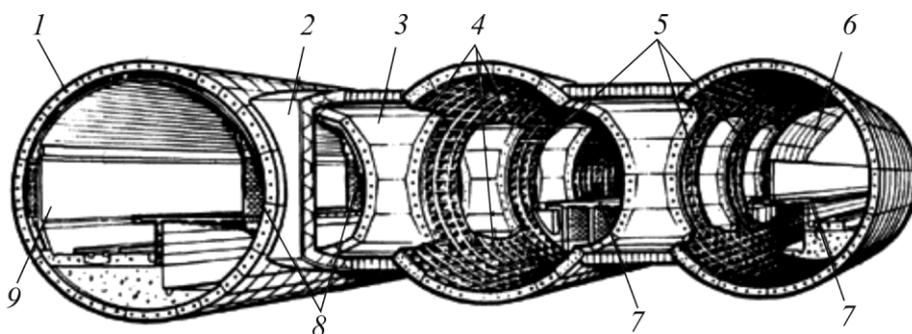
Трехсводчатая схема пилонной станции с чугунной обделкой: 1 – нормальное тьюбинговое кольцо в глухой части станции; 2 – железобетонная обделка прохода; 3 – проход; 4 – клинчатая перемычка проемной станции; 5 – пилон; 6 – водоотводящий зонт; 7 – платформа; 8 – обстройка пилонной части; 9 – путевая стена
